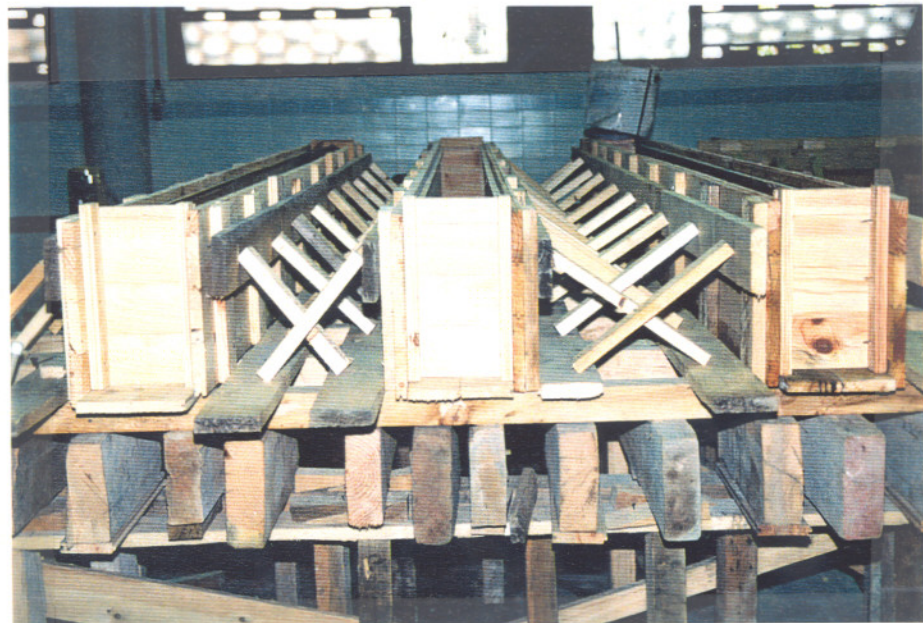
Detalle del encofrado de las vigas. La bancada construida para soportar los encofrados de las vigas destinadas a ensayo de rotura permitfa descimbrar cada una de ellas por separado.
